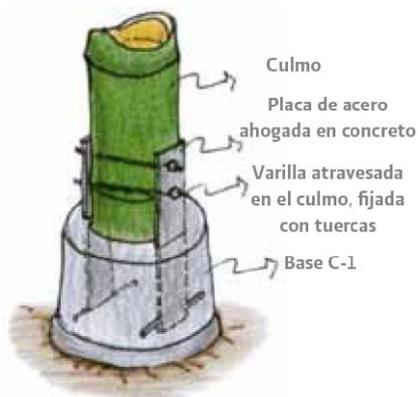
Anclaje de columnas, pies derechos y verticales a la cimentación con solera de acero y pernos.
